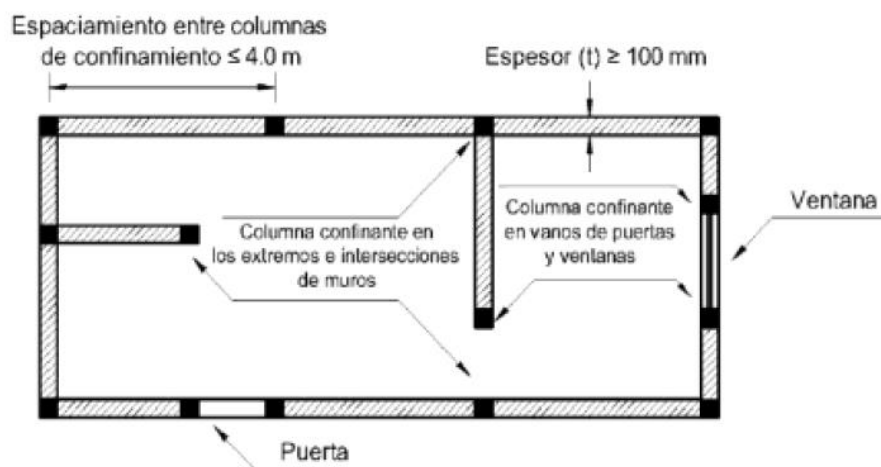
Ubicación de Pilares o Columnas de Confinamiento.
